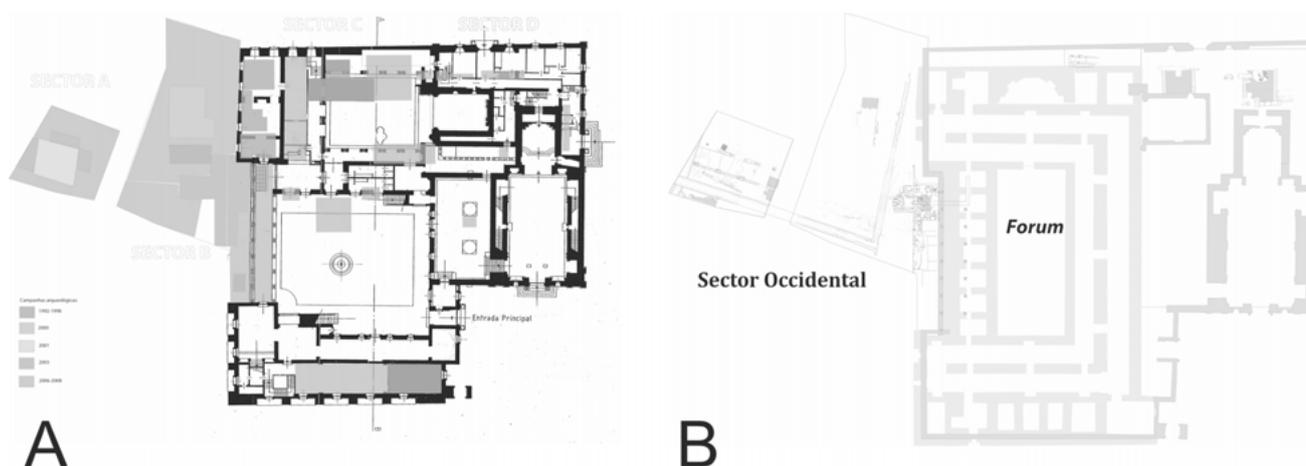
A. Zonas de intervención arqueológica sobre el actual edificio del Museo Machado de Castro. B. Localización y planimetría de los sectores excavados.
